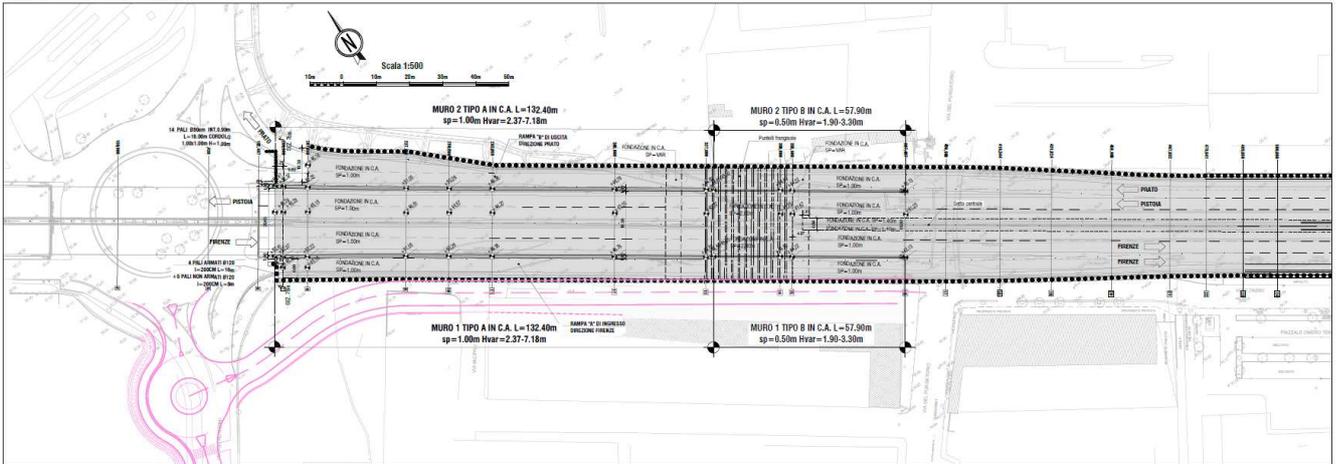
Stralcio planimetrico muri rampe di svicolo
